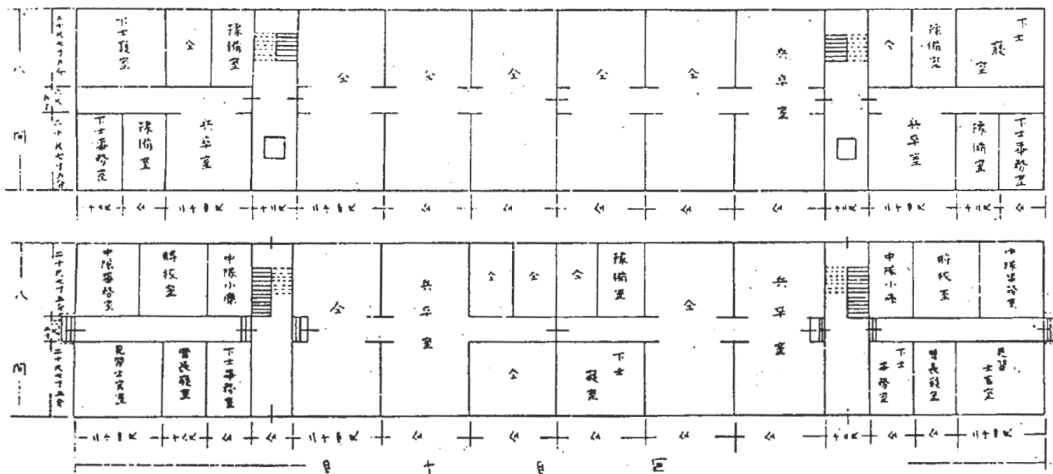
兵舎 模範平面図 下：1階，上：2階<sup>21)</sup>
